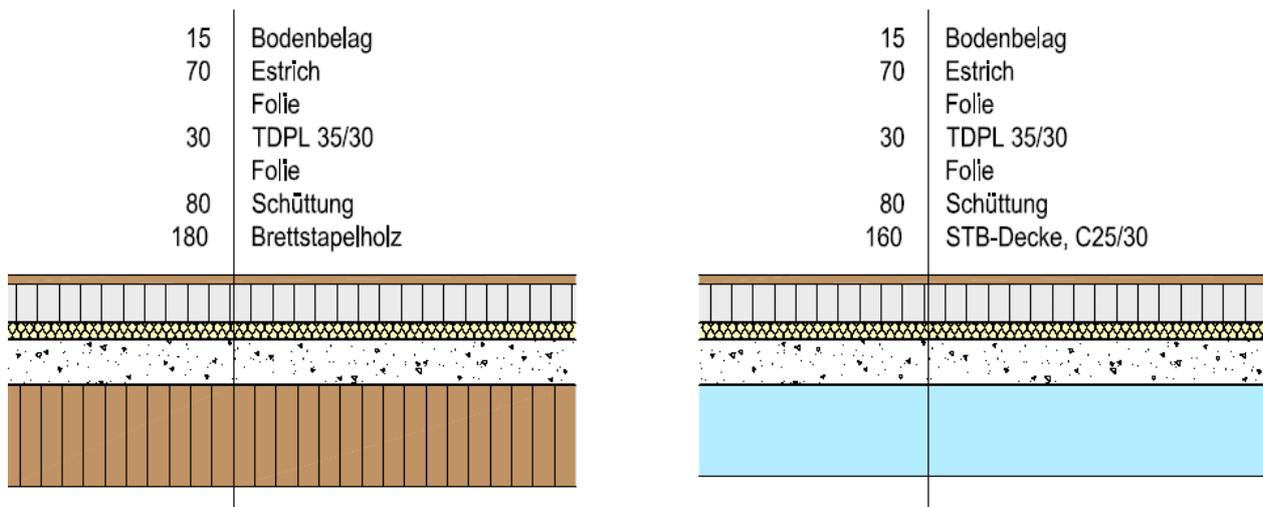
Deckenaufbau Brettstapeldecke – Stahlbetondecke
